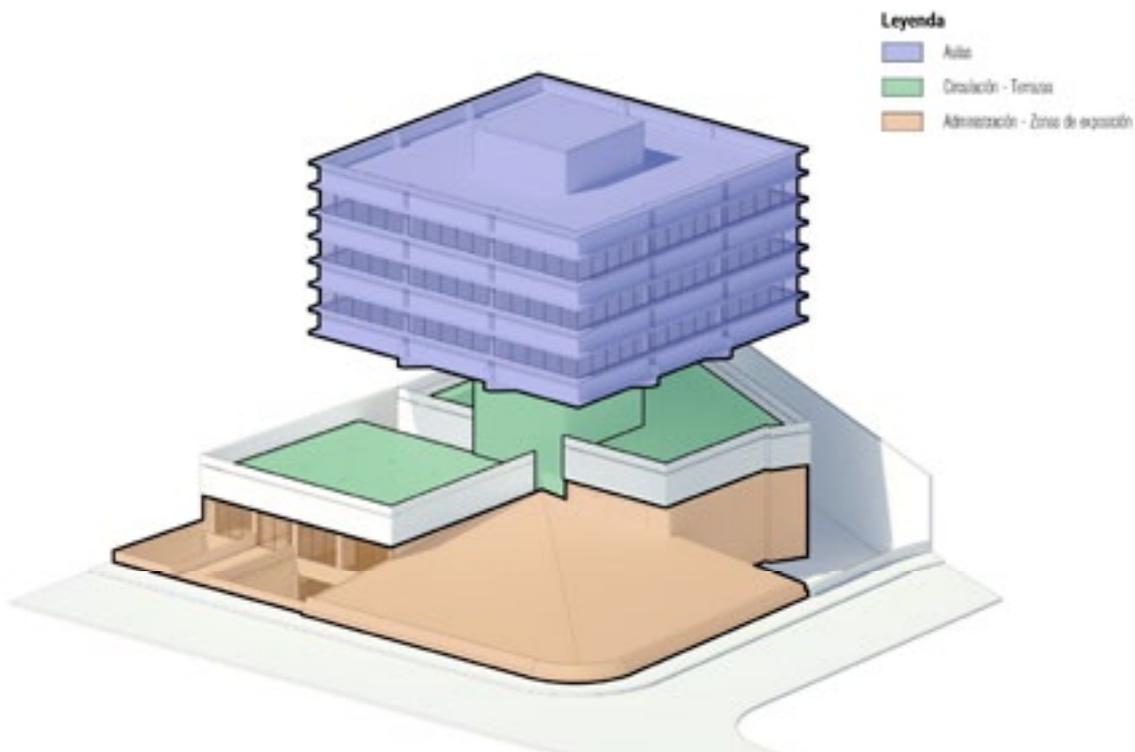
Plano mostrando usos en planta baja. Elaboración propia
